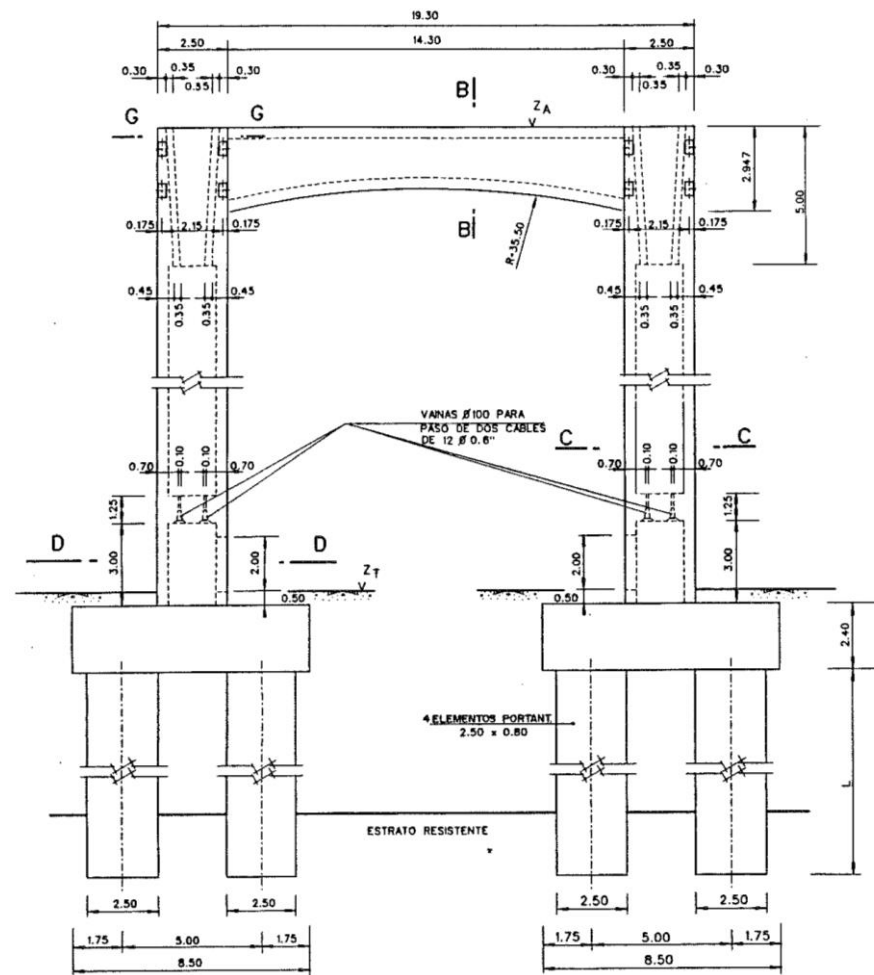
Alzado de la cimentación de las pilas P-13 y P-16 (copiada del Proyecto Modificado n° 1)
